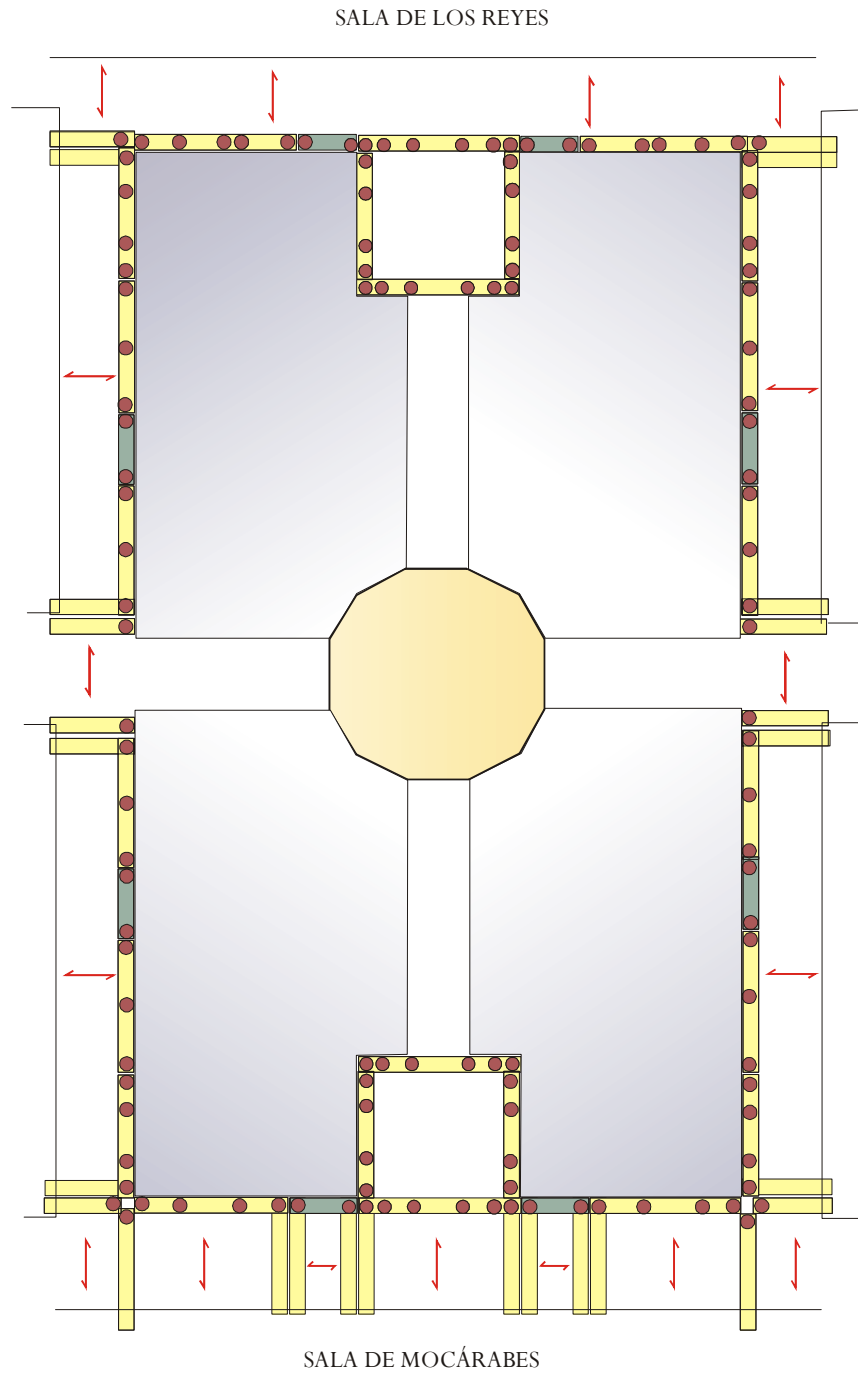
Disposición de vigas dobles en la galería que discurre por delante de la Sala de Mocárabes.
